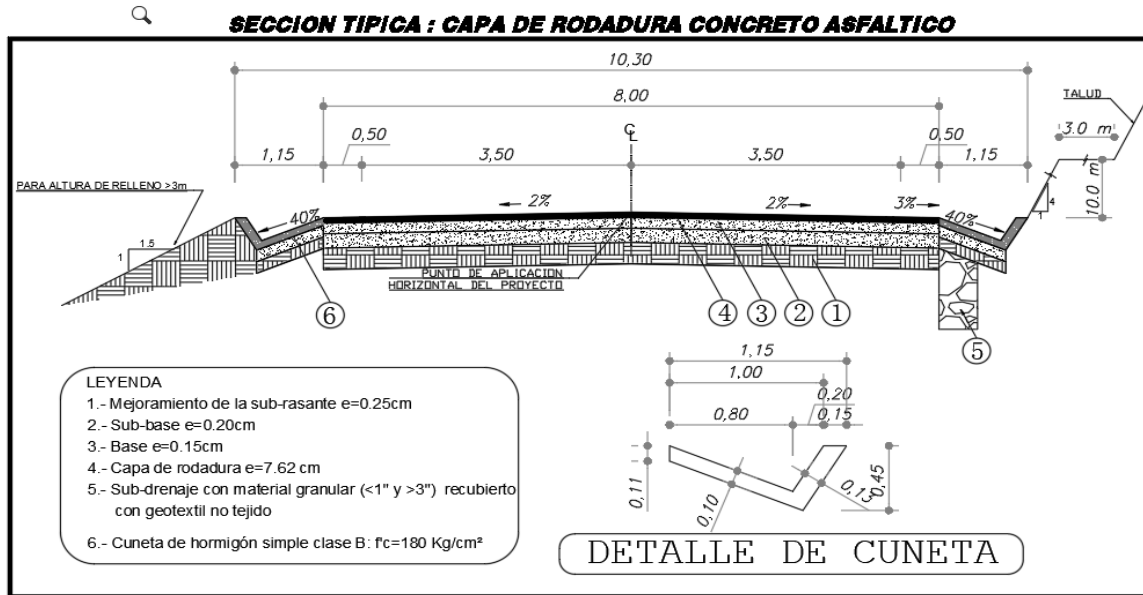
Sección Típica de Capa de Rodadura de Concreto Asfáltico
